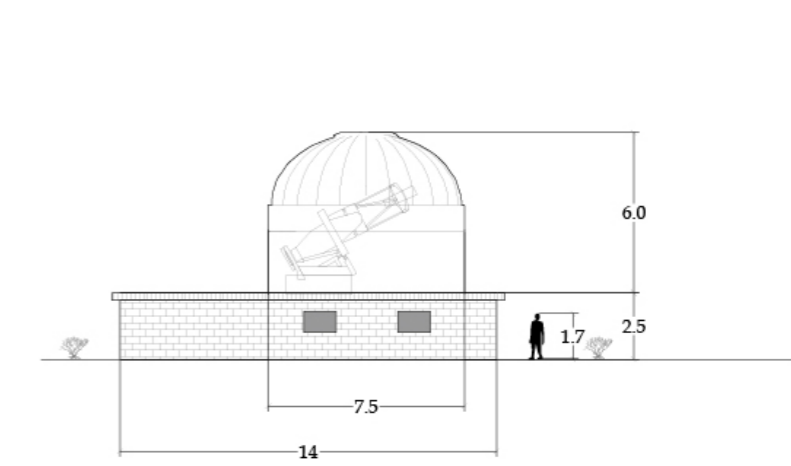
Elevaciones de los Observatorios en estado "dado de baja" en base a levantamiento fotográfico. Elaboración propia
